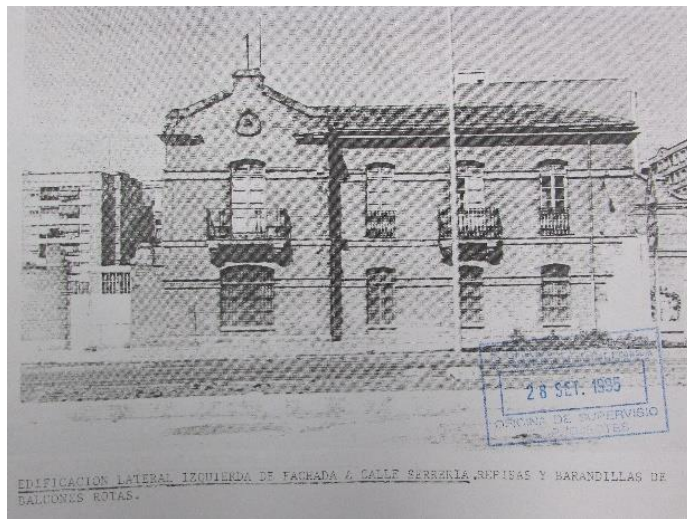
Vista del pabellón delantero ubicado al lado izquierdo de la fachada principal del antiguo Matadero del Distrito del Puerto. (Fuente: Sanchis, Murcia y García, 1995)
